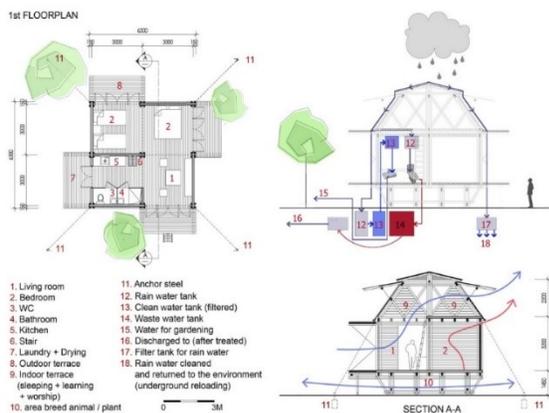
Planta y cortes. Fuente: (H&P Architects, 2013)
